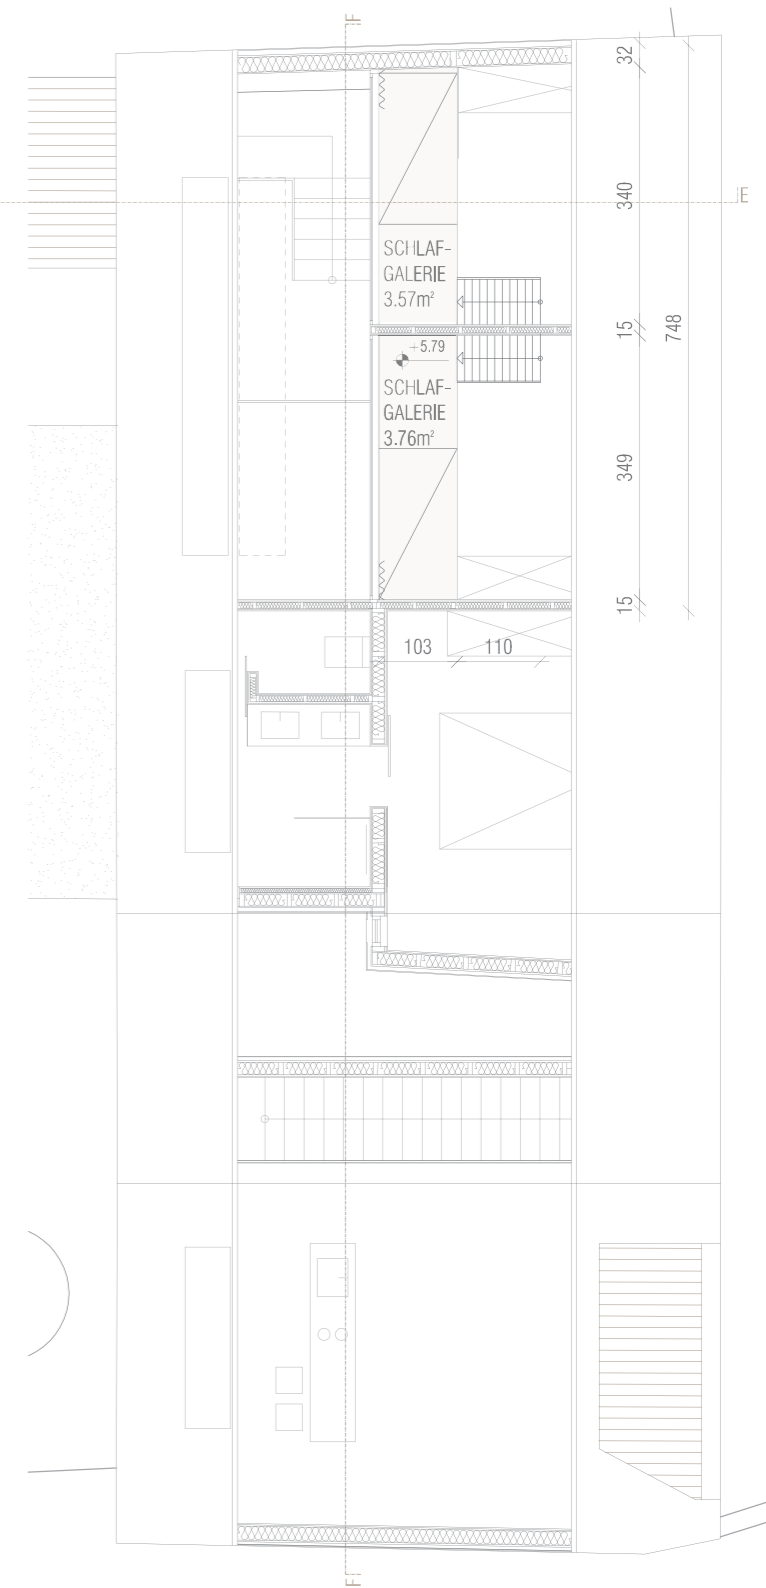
Gebäude C_ELTERNHAUS_Schlafgalerien im Firstbereich Maßstab 1:100
